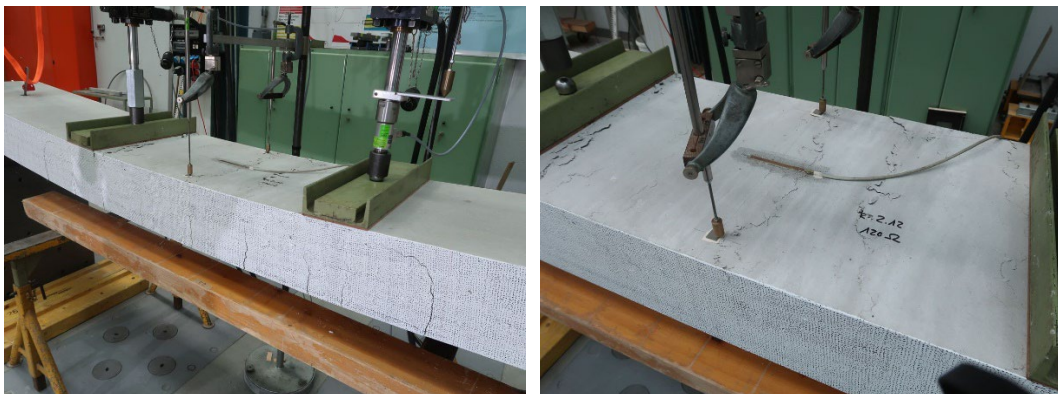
Links: Betonstauchen der Platte 7 am Ende des Versuches. Rechts: Nahaufnahme des Betonstauchens.
